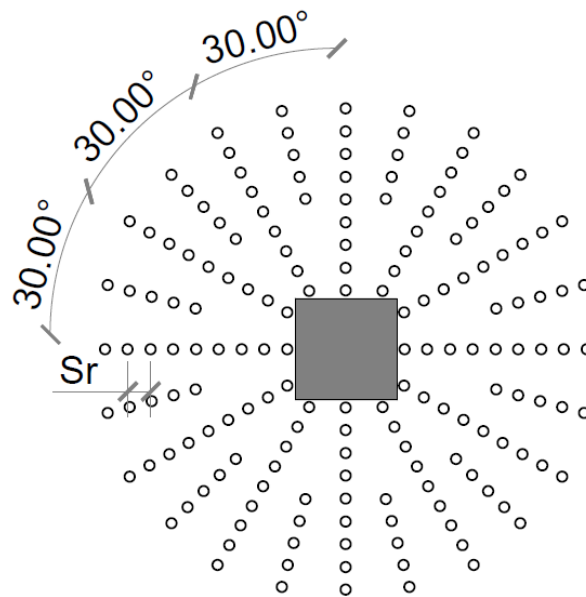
Detalhe da armadura de cisalhamento das lajes compostas por nove camadas de *studs
